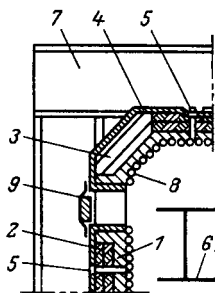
Угол топочной камеры с натрубной обмуровкой (горизонтальный разрез).
